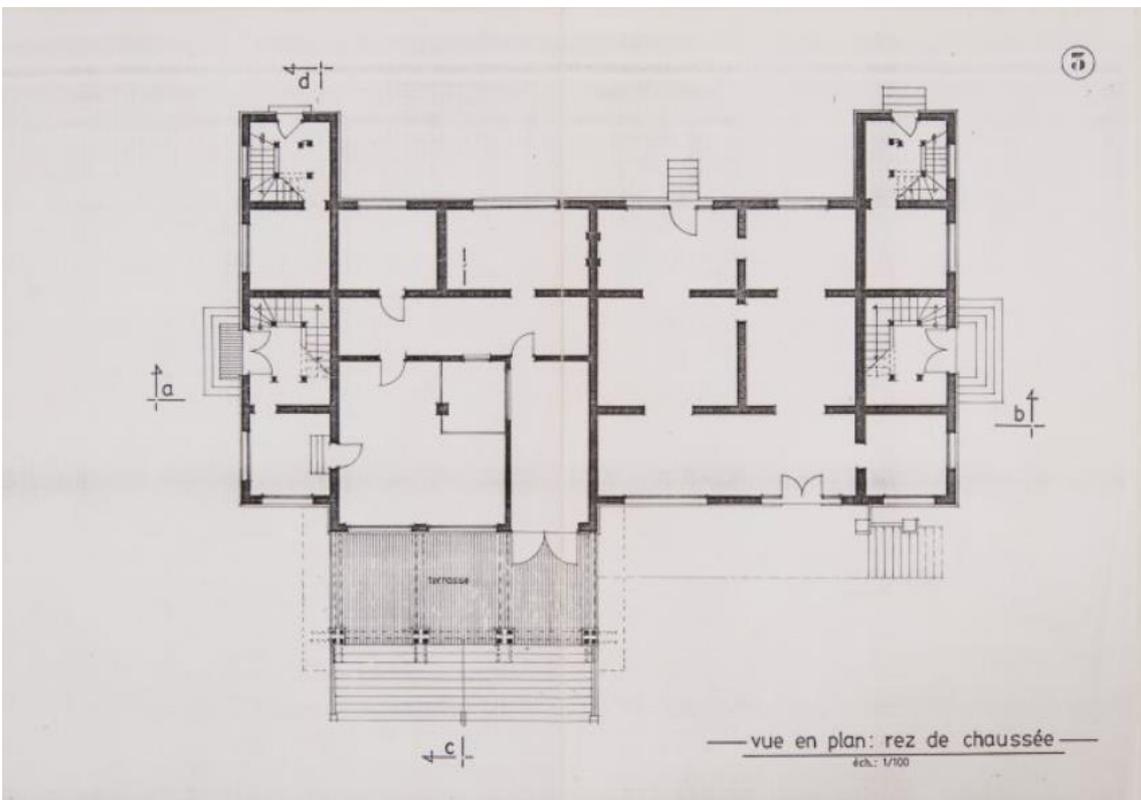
plano de la planta baja de la Casa do Benin, 1989, archivo Instituto Bardi
